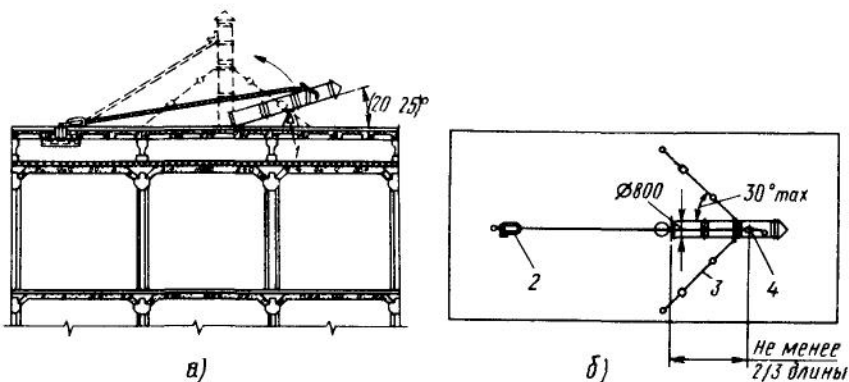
Монтаж вентиляционных шахт с использованием лебедки:
